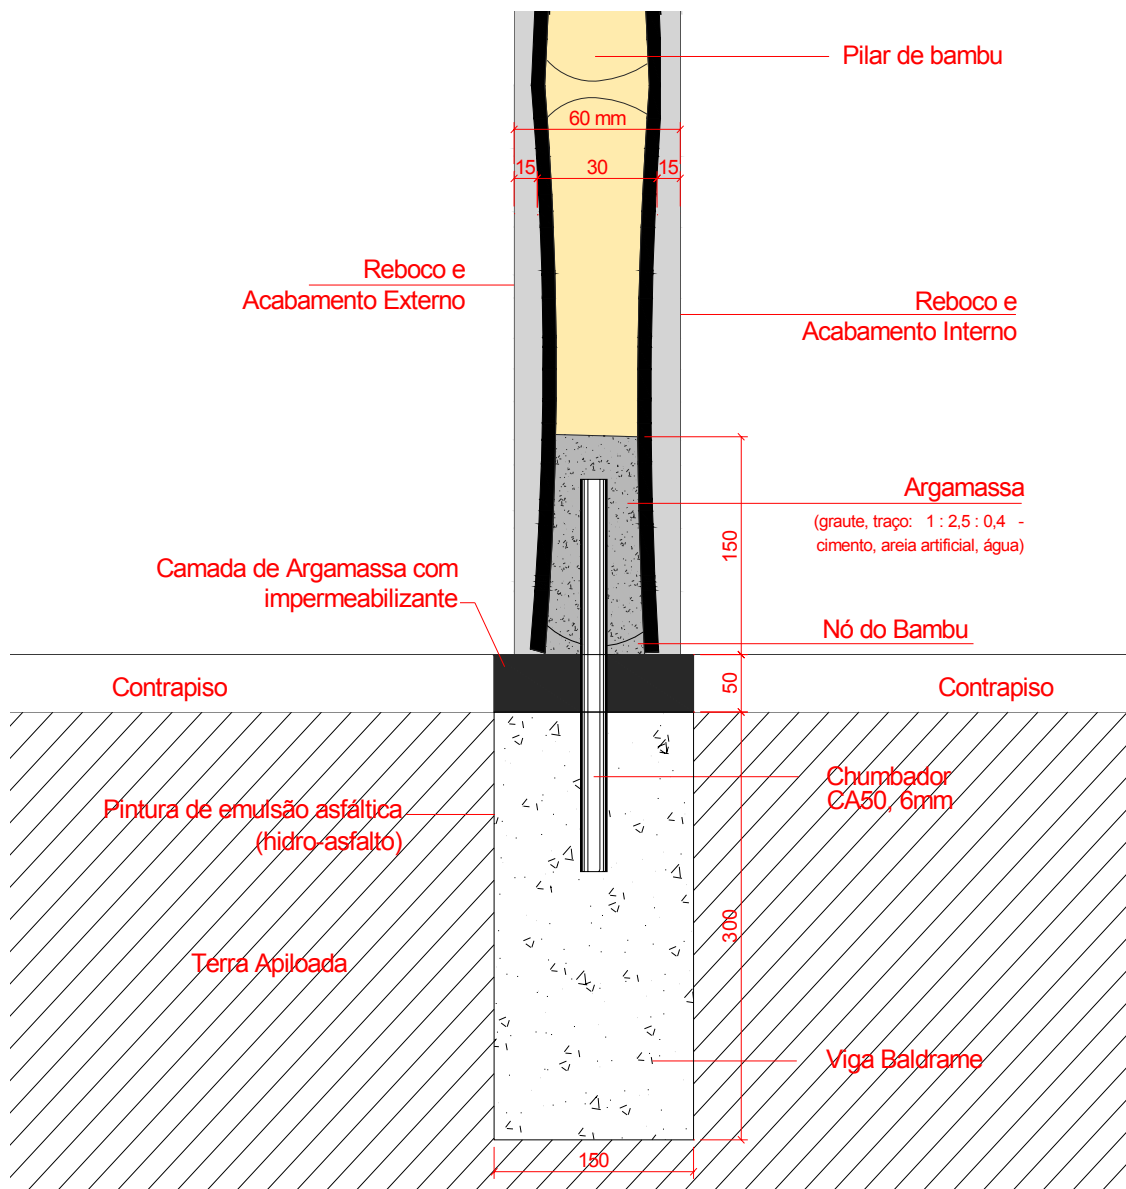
Detalhe da fundação e fixação do pilar de bambu.
